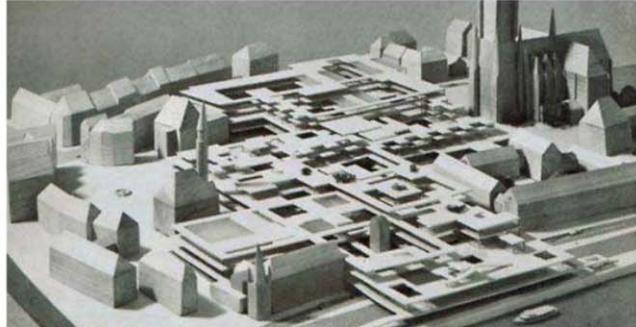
Propuesta para la reconstrucción de Frankfurt-Römerberg en la que Candilis, Josic y Woods plantean por primera vez un mat-building. Avermaete (2005) *Another Modern. The post-war architecture and urbanism of Candilis-Josic-Woods*. Amsterdam. Nai Publishers p. 312
